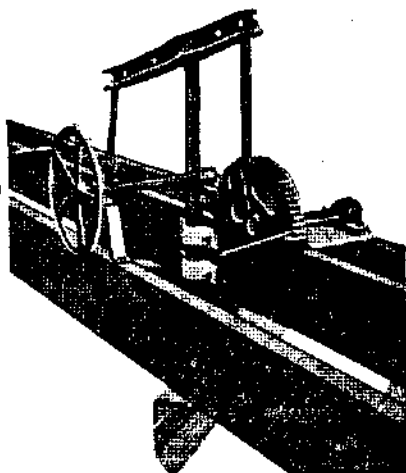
Детали субгрейдера Лейквуд. Приспособление для подъема 6 м субгрейдера перед установкой больших колес для перевозки его.
